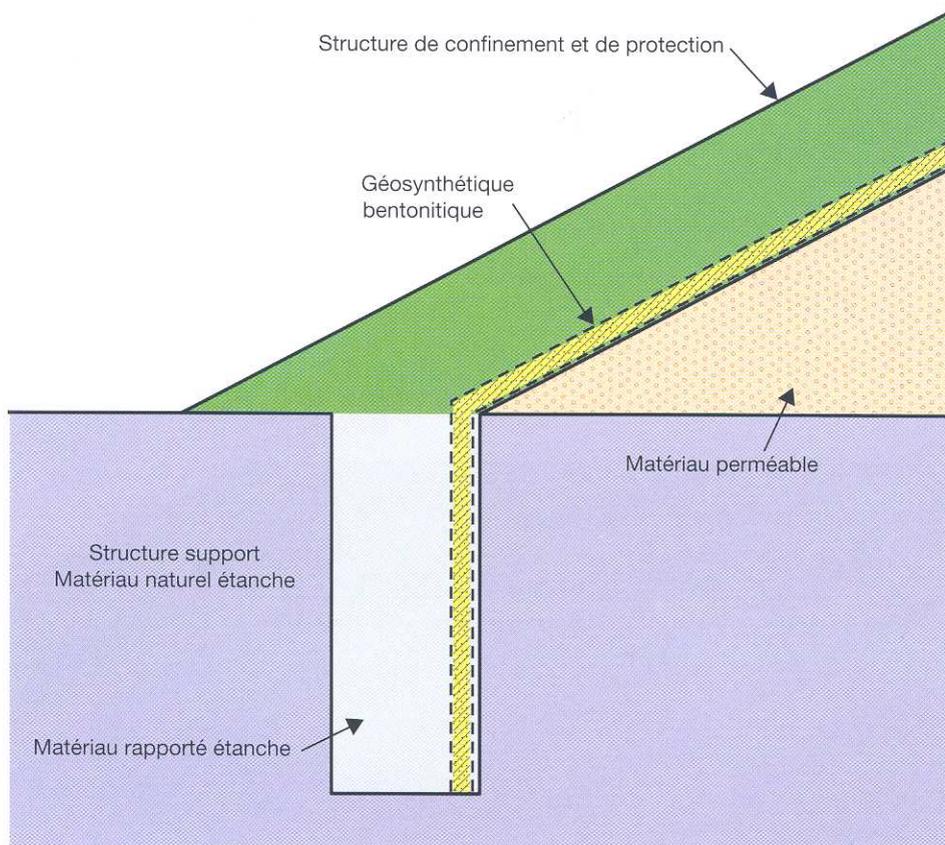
Raccord en tranchée avec apport de matériau étanche
